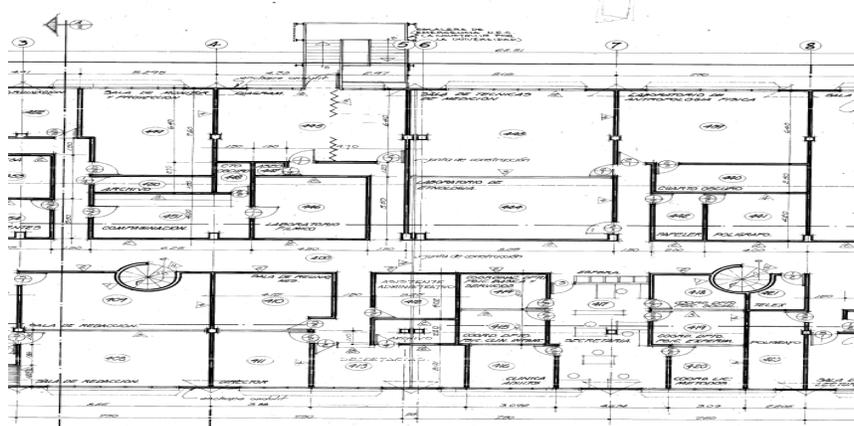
Vista en planta de parte de la remodelación propuesta en 1977.
